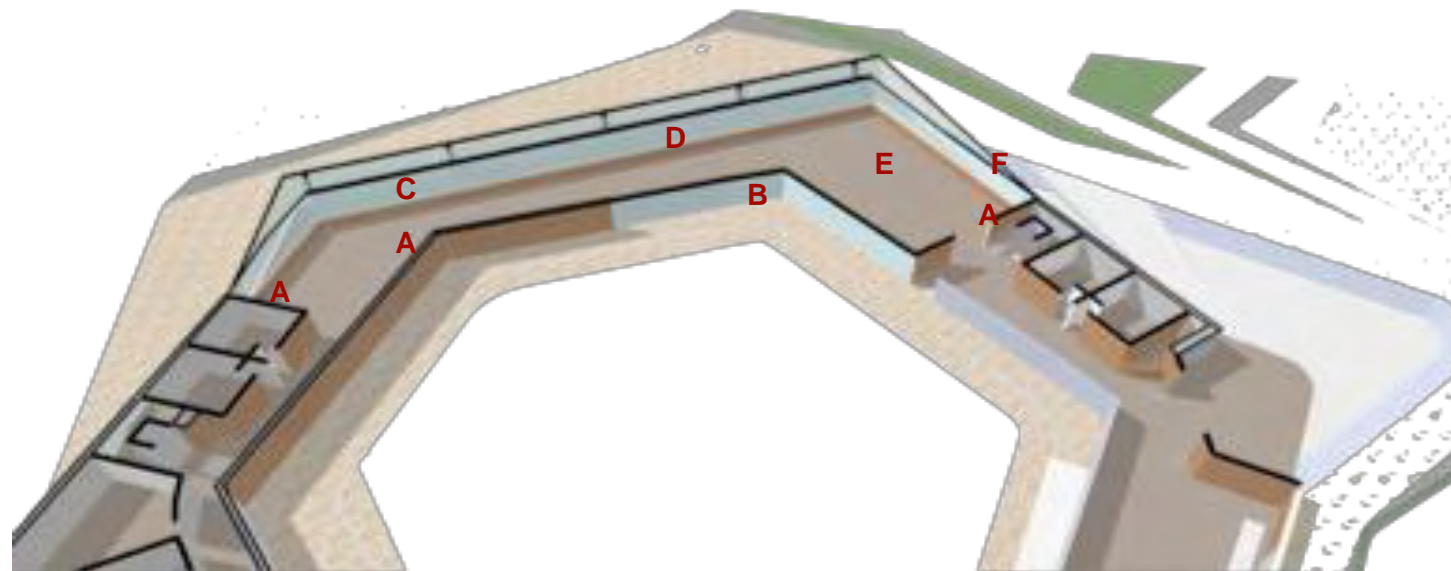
Planta esquemática de área de lectura y materiales de construcción.
